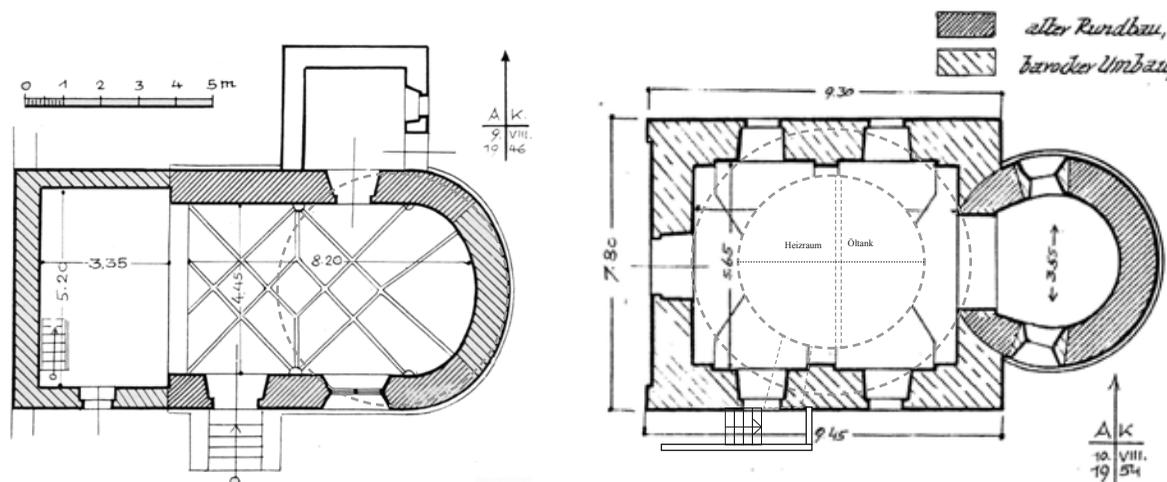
Grundriss des Obergeschosses in Tragöß N° 38, M 1:200. Klar 1946, Planarchiv BDA Steiermark.
